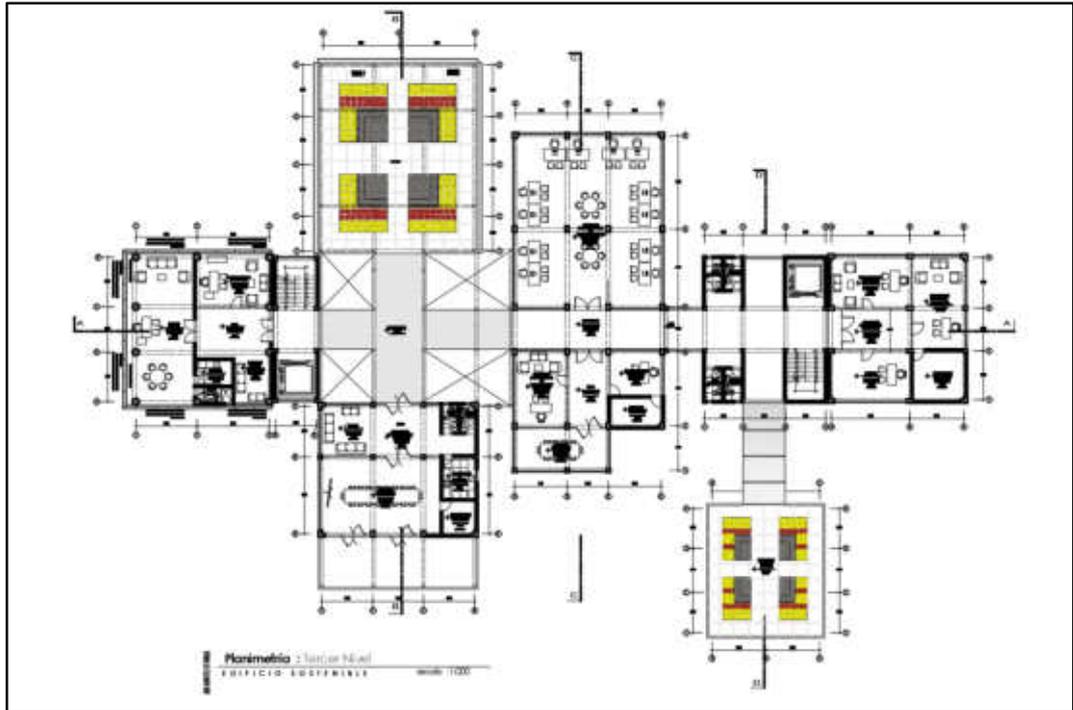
Planimetría Tercer nivel ANTEPROYECTO
